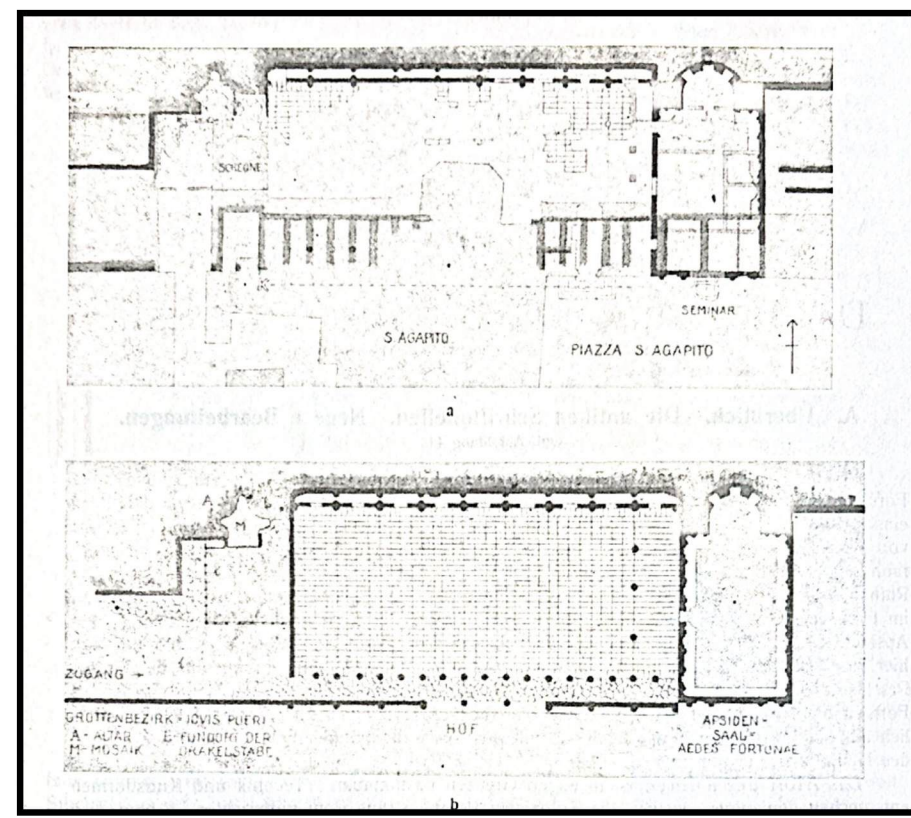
Planimetria degli edifici dell'area del Foro (Delbrueck 1907, p. 48)
